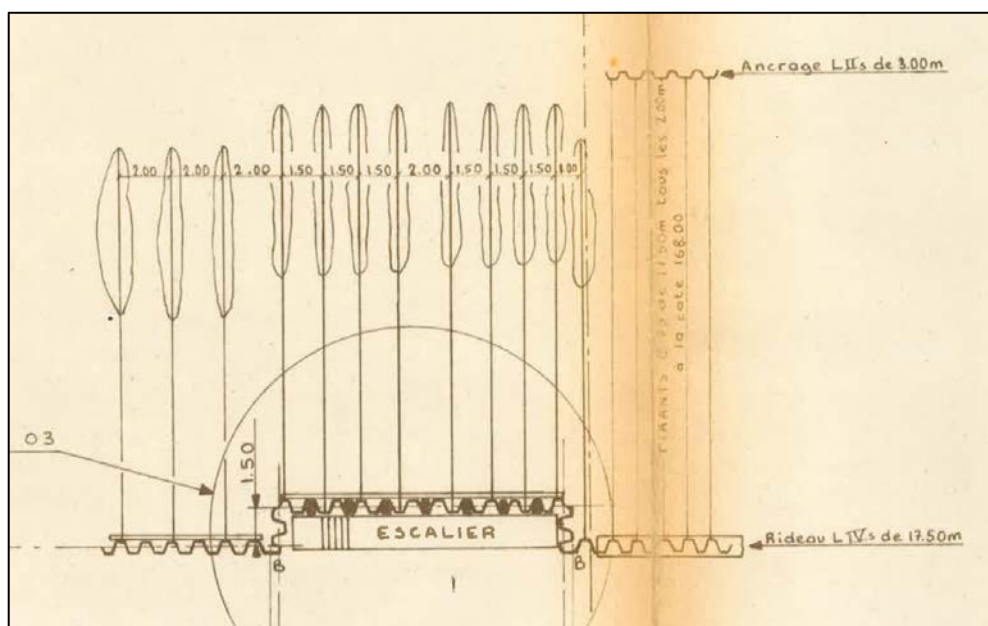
Extrait plan de construction du tronçon 2 montrant la configuration du tronçon 1 (source n°34)
